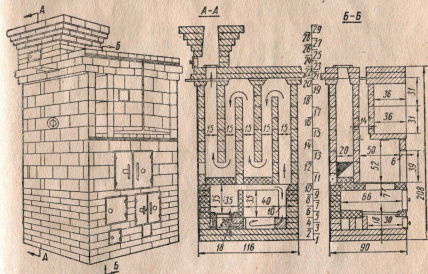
Шведка увеличенная пятиоборотная конструкции К. Я. Буслаева.
